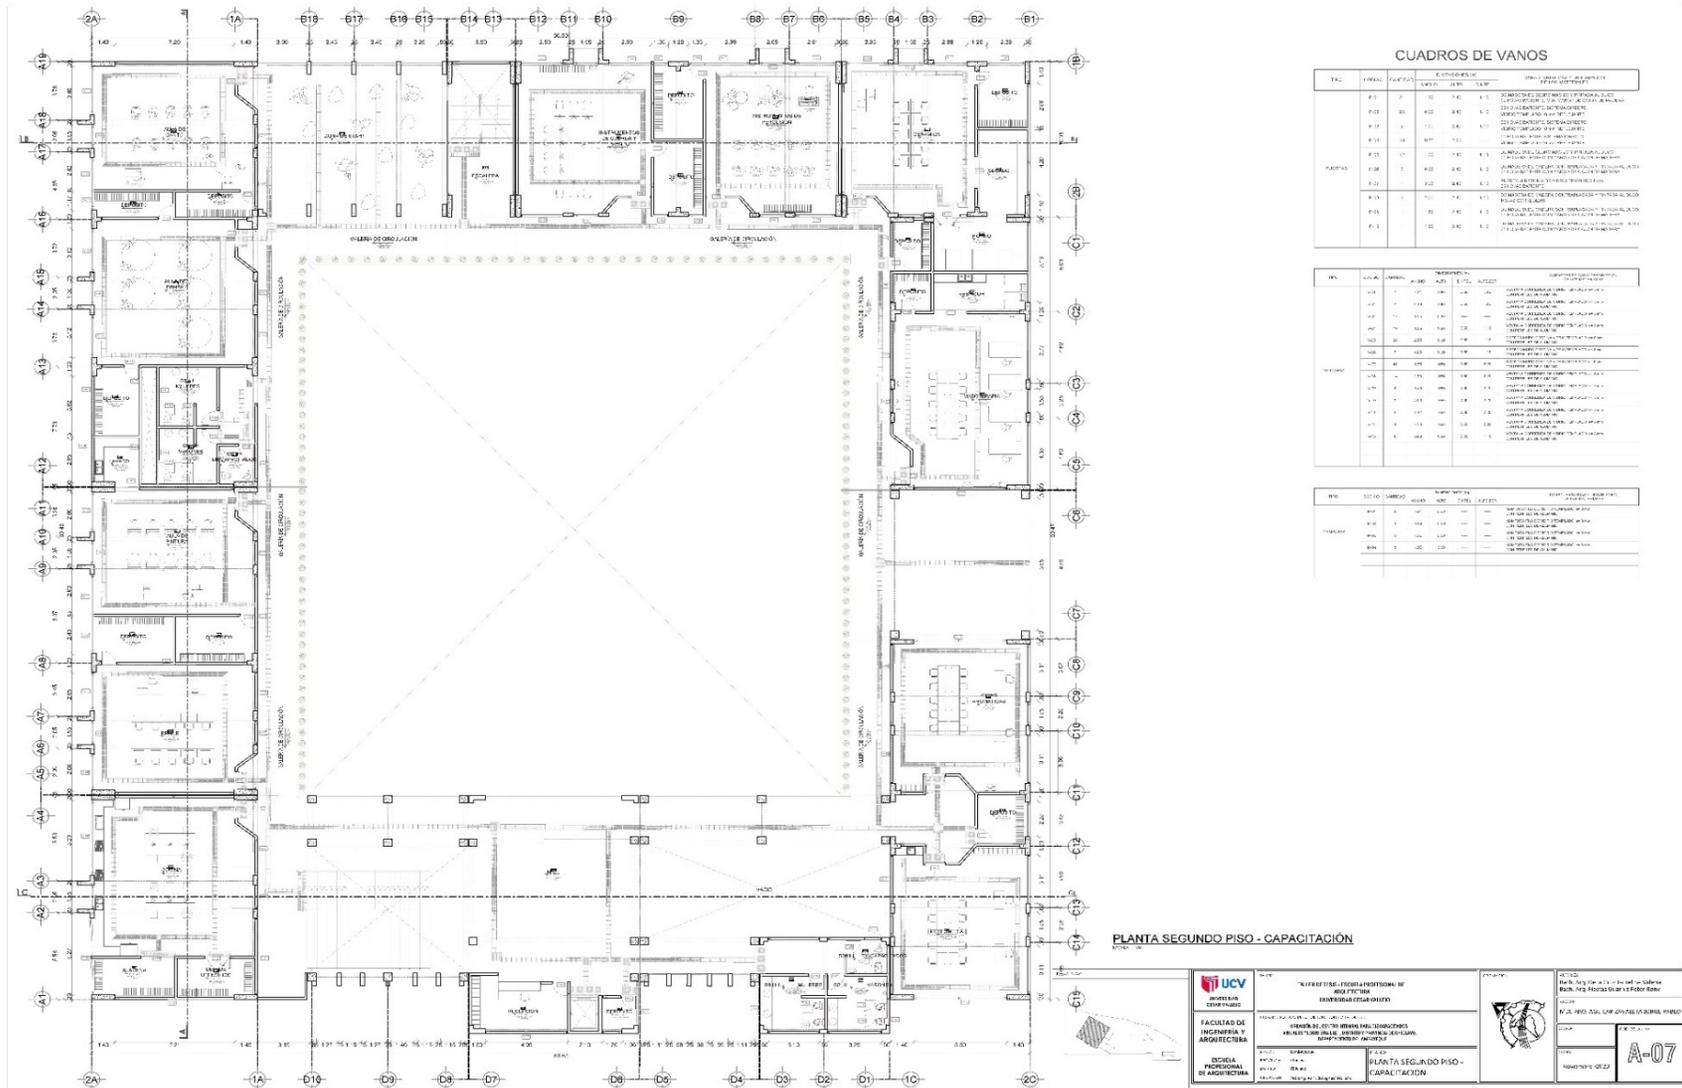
Planta segundo nivel-zona de capacitación. Fuente elaboración propia.
